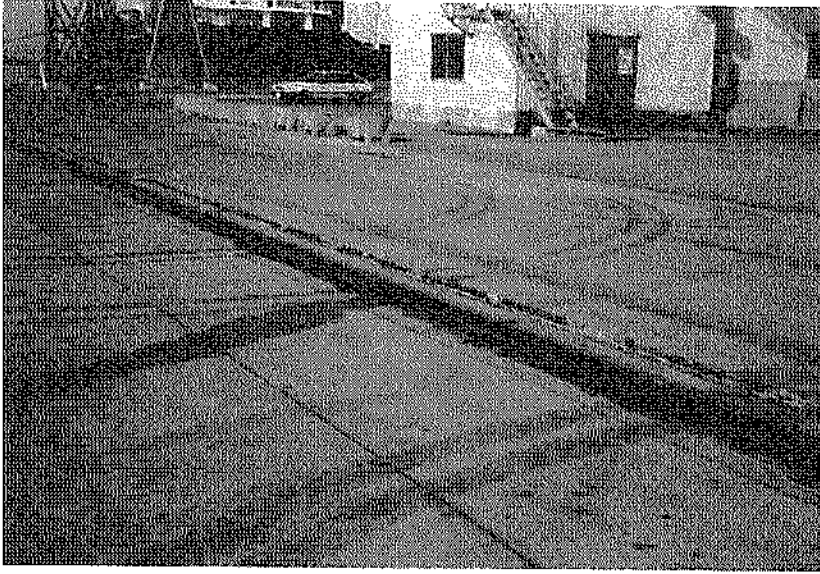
アンローダーレール位置の段差状況 (第3埠頭地区, ⑤南側岸壁(-12.0m))
